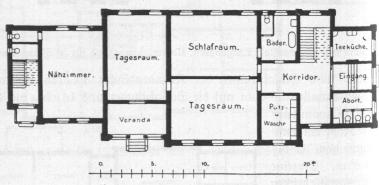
Jrrenanstalt Langenhorn, Landhaus für Frauen, Erdgeschof, Grundrif.
